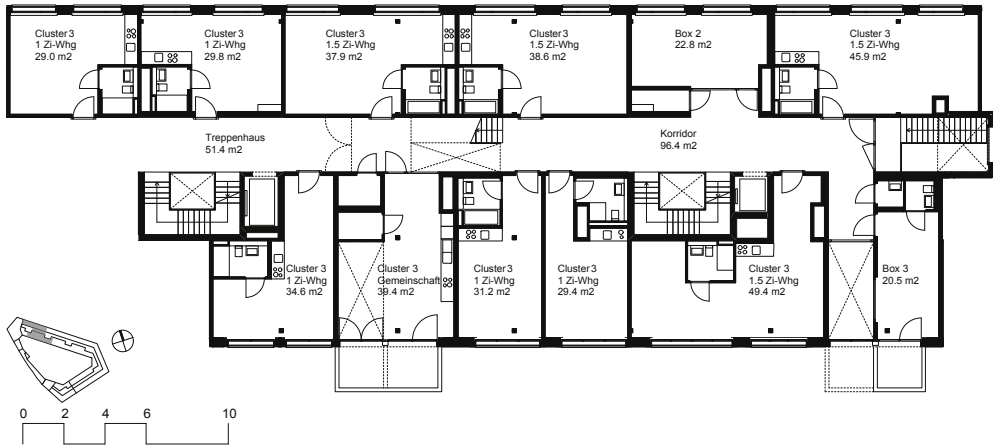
Kalkbreite, Grundriss Wohncluster, Müller Sigrist Architekten AG, Zürich
